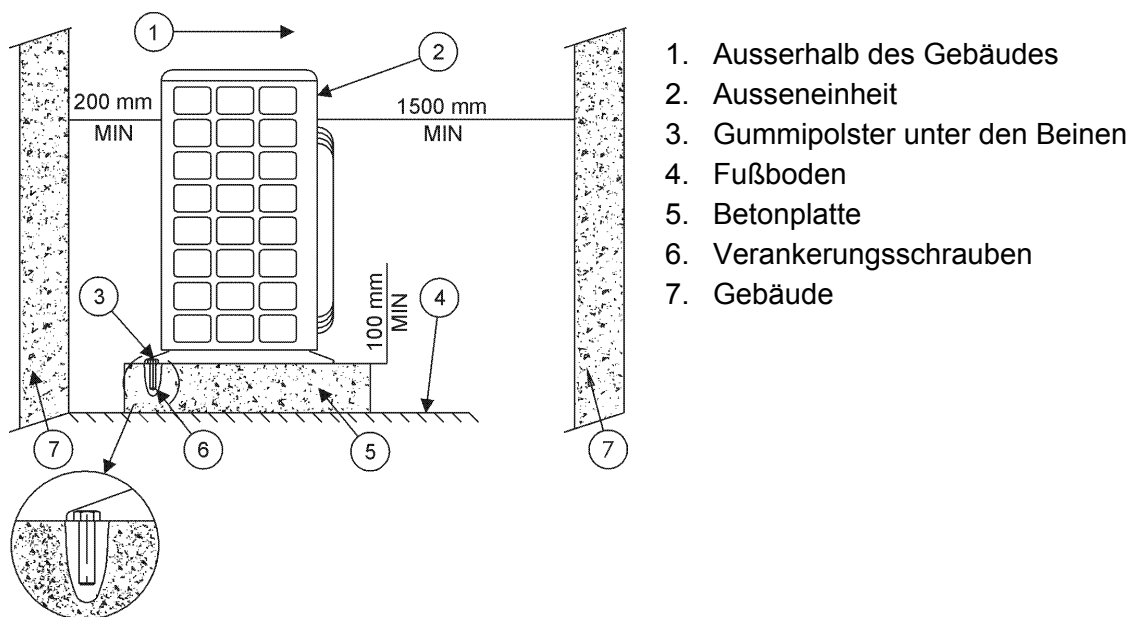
Installation der Ausseneinheit auf einer Betonplatte
